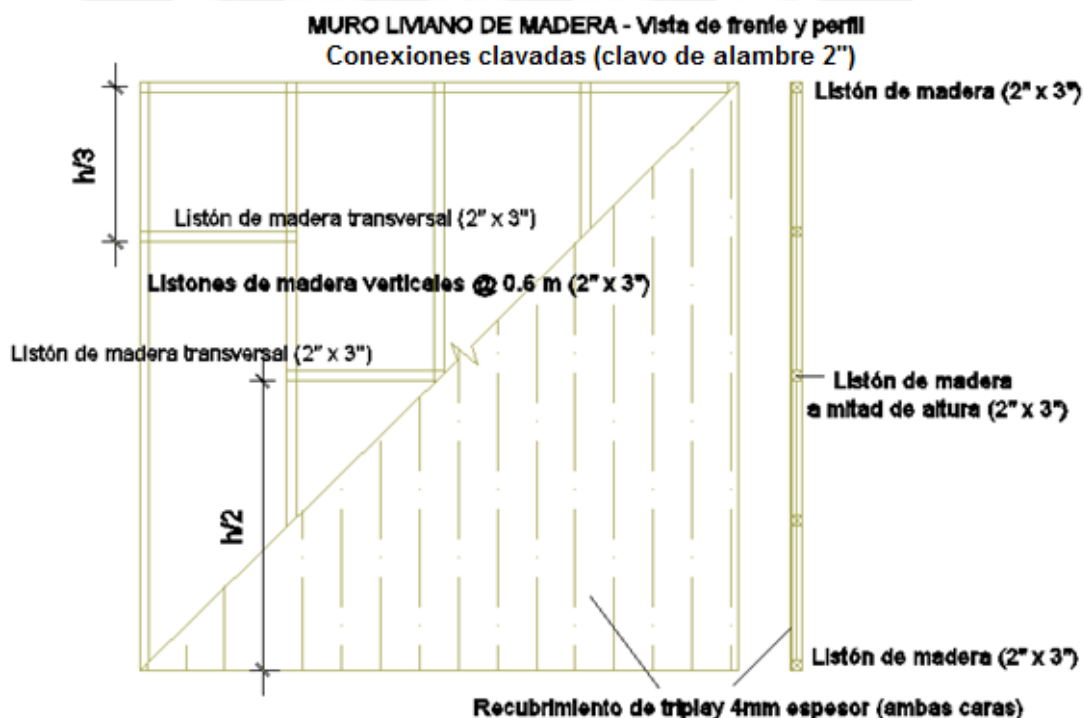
Esquema de muro liviano de madera – Elemento divisorio NO estructural
